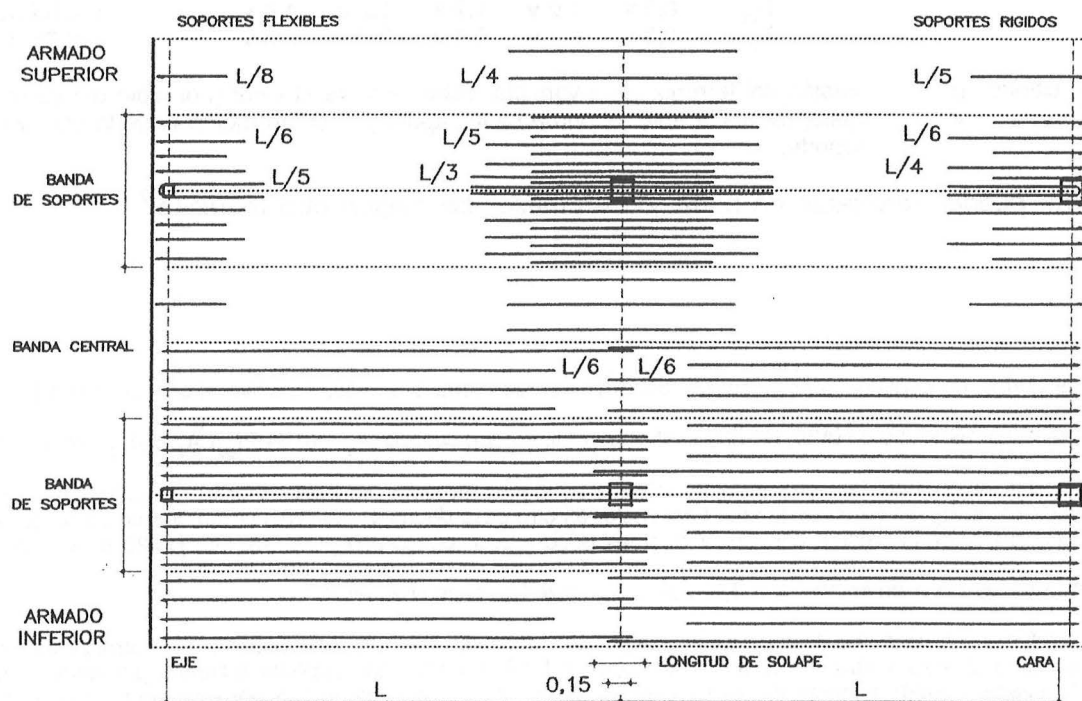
Despiece de armaduras en losas con soportes aislados
